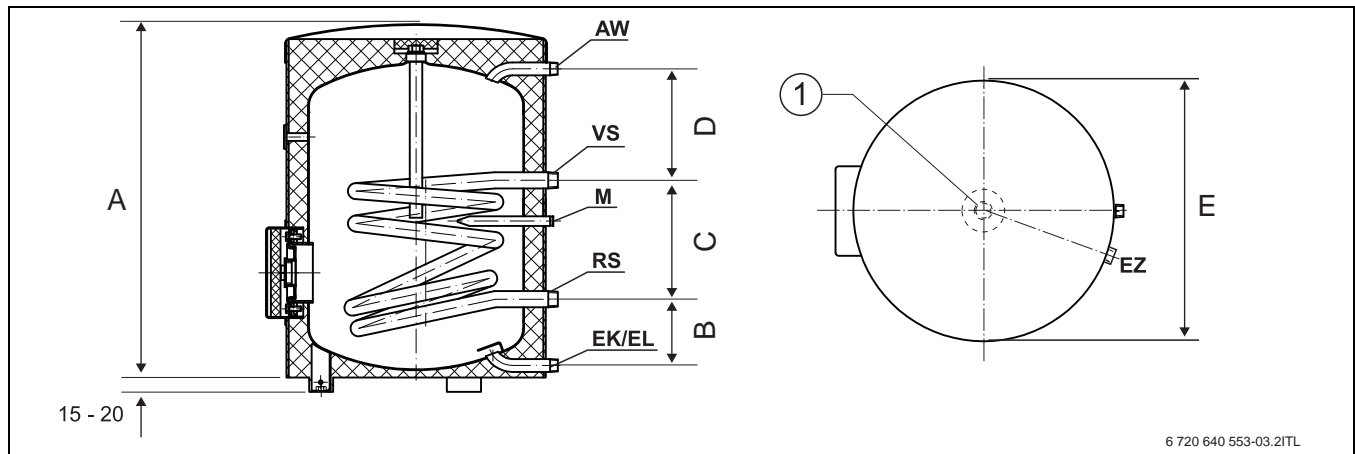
Abmessungen und Anschlüsse Storazell S75 – 90 ZB-solar
